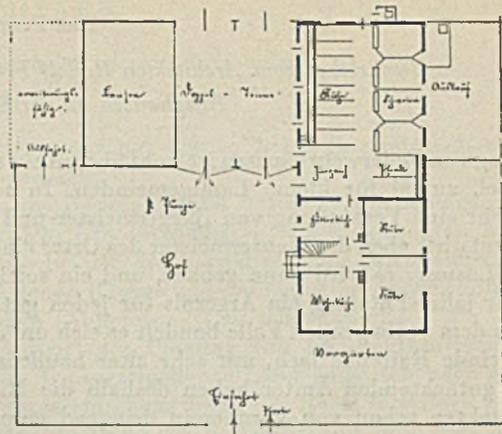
(rechts). Grundriß einer 80-Morgen-Neubaustelle
